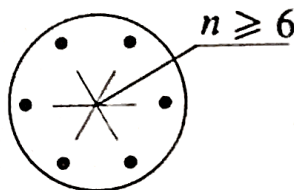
Nombre minimal des barres longitudinales pour une section circulaire
